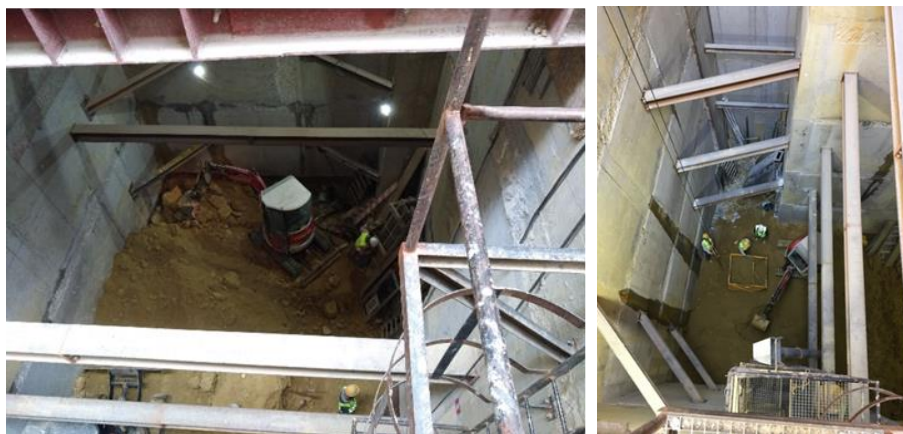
Escavação e contenção periférico do estacionamento enterrado
